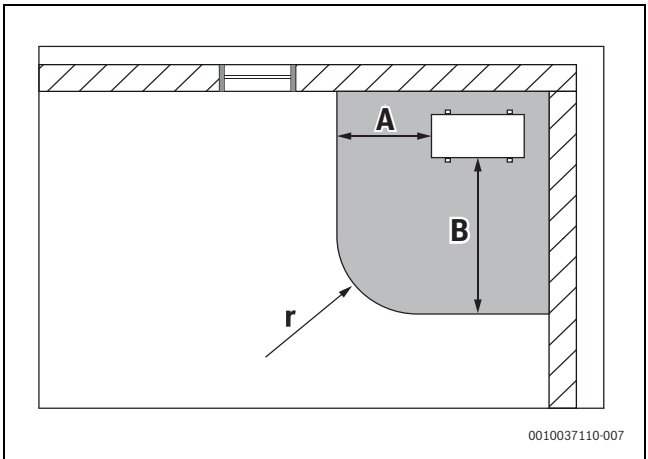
Zona di sicurezza posizionamento a terra in un angolo, vista dall'alto
